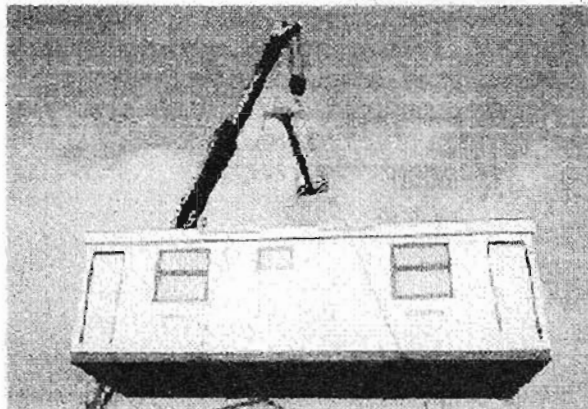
Vivienda SABINCO prefabricada en faena de transporte.
